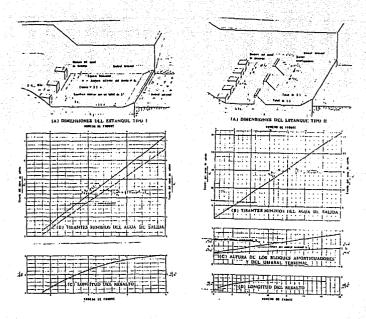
TANOUE AMORTIGUADOR PARA NUMEROS DE FROUDE ENTRE -- 2.5 - 4.5 (U.S.B.R.)
